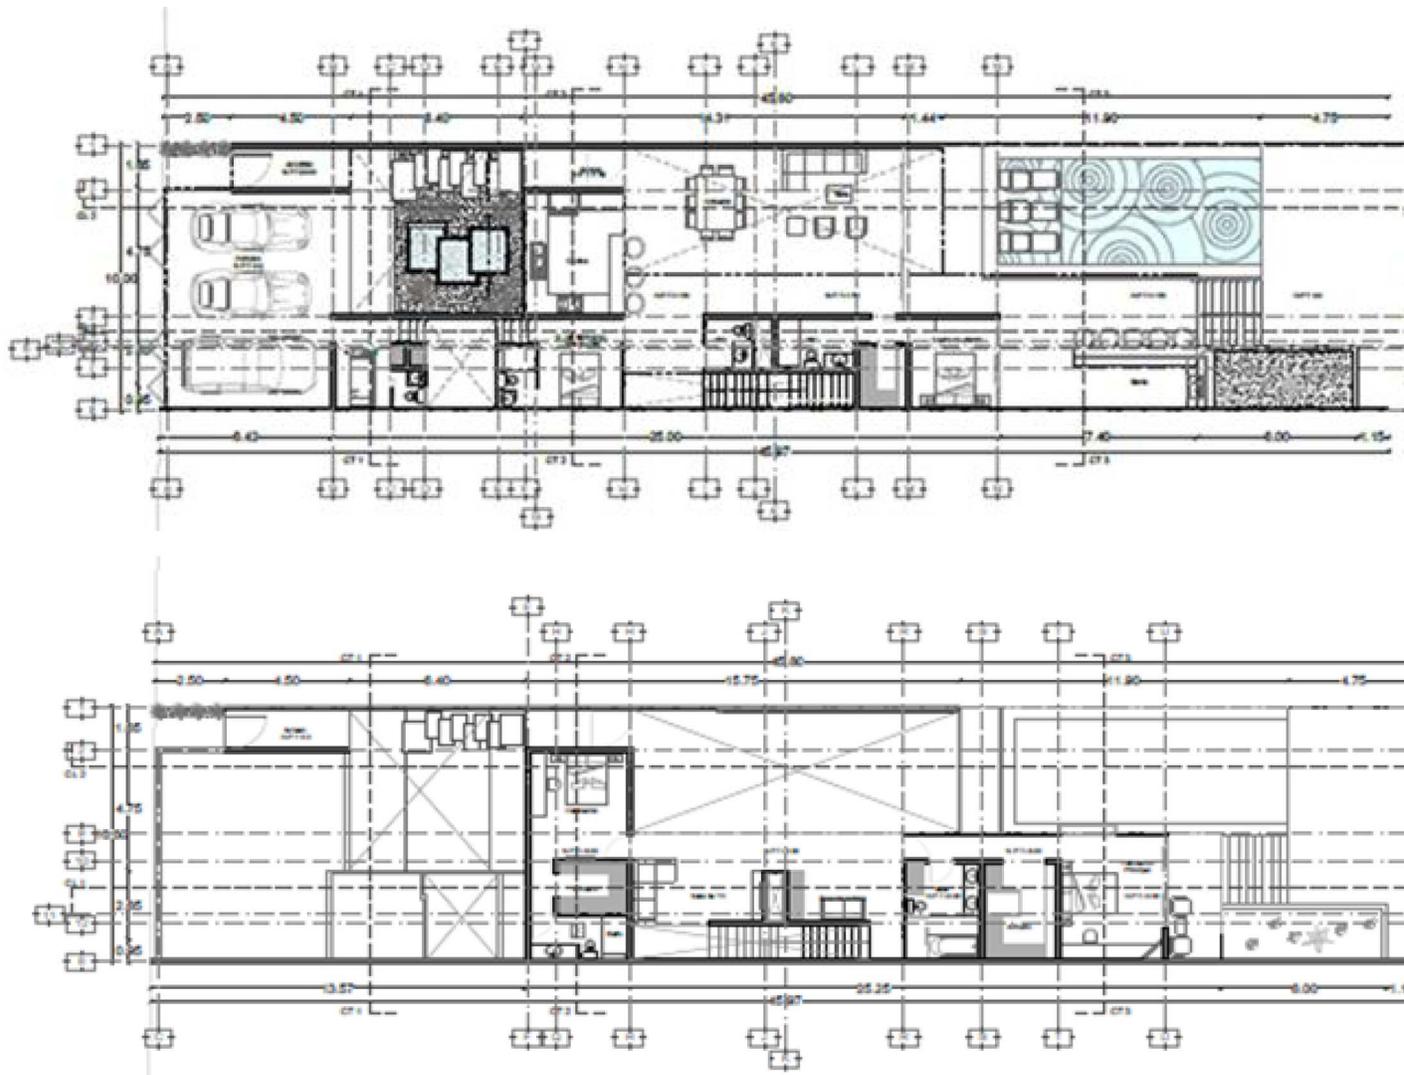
Planta arquitectónica sin escala: A) Planta baja y B) Planta alta
